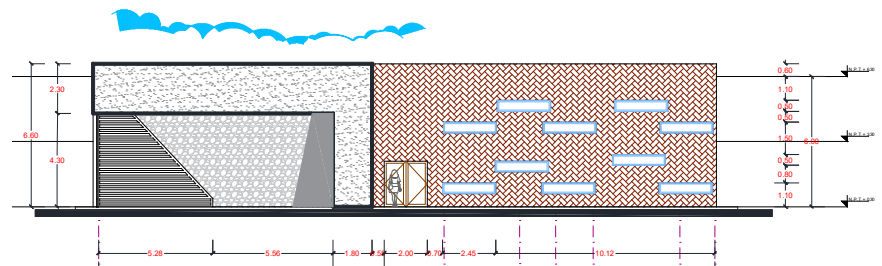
Propuesta Restaurante, Fachada Noroeste (Anexos Plano: 3-FACH-REST-01)
